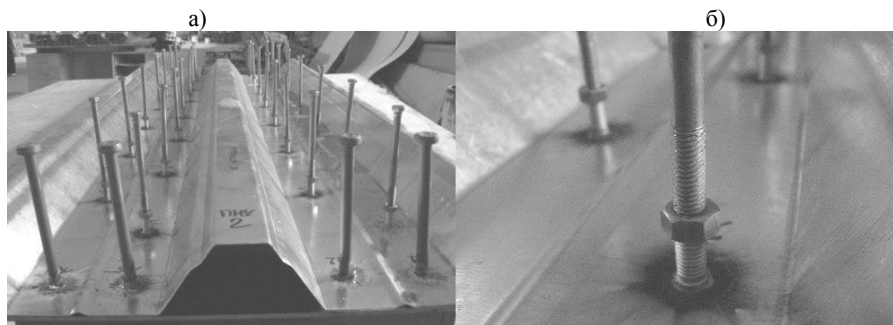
Общий вид двуглофрового элемента настила для образца серия ПНУ (а); вид на приварной болт с гайкой и дополнительным болтом (б)
